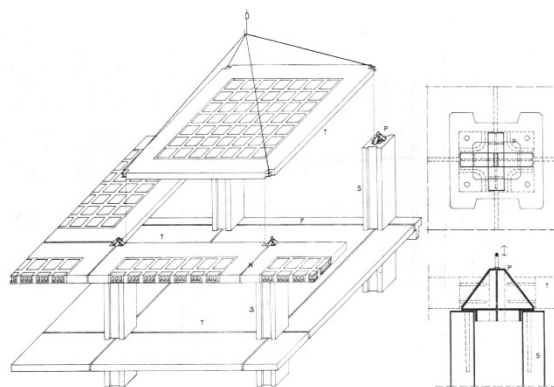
Koncept konstrukcije IMS sistema (Muravljov, 2010)
